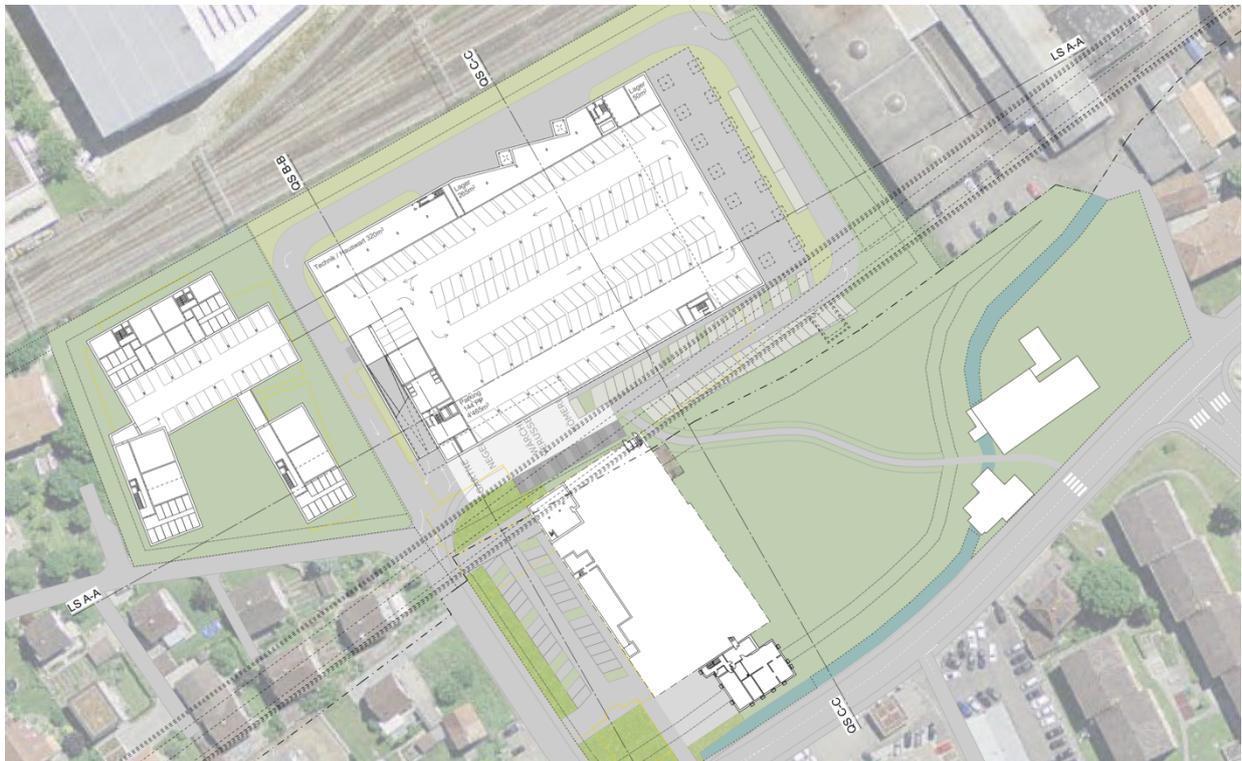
Verlauf der Tunnelröhre (Grundriss Untergeschoss Richtprojekt), Januar 2021
